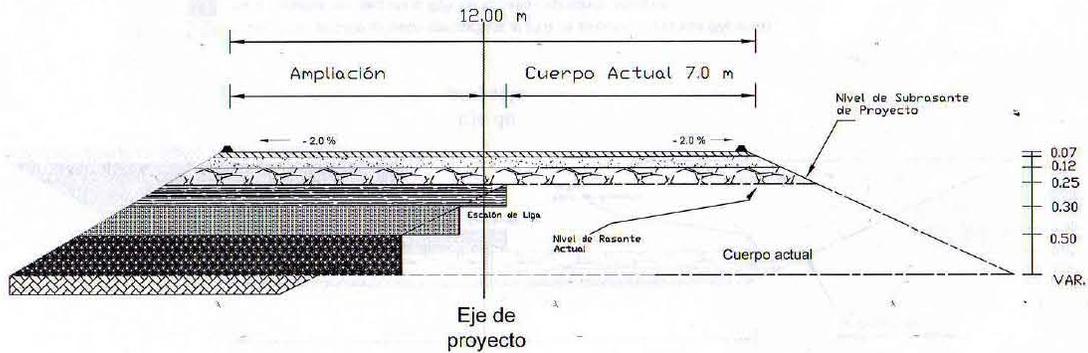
B SECCIÓN TIPO DEL CAMINO A CONSTRUIR
